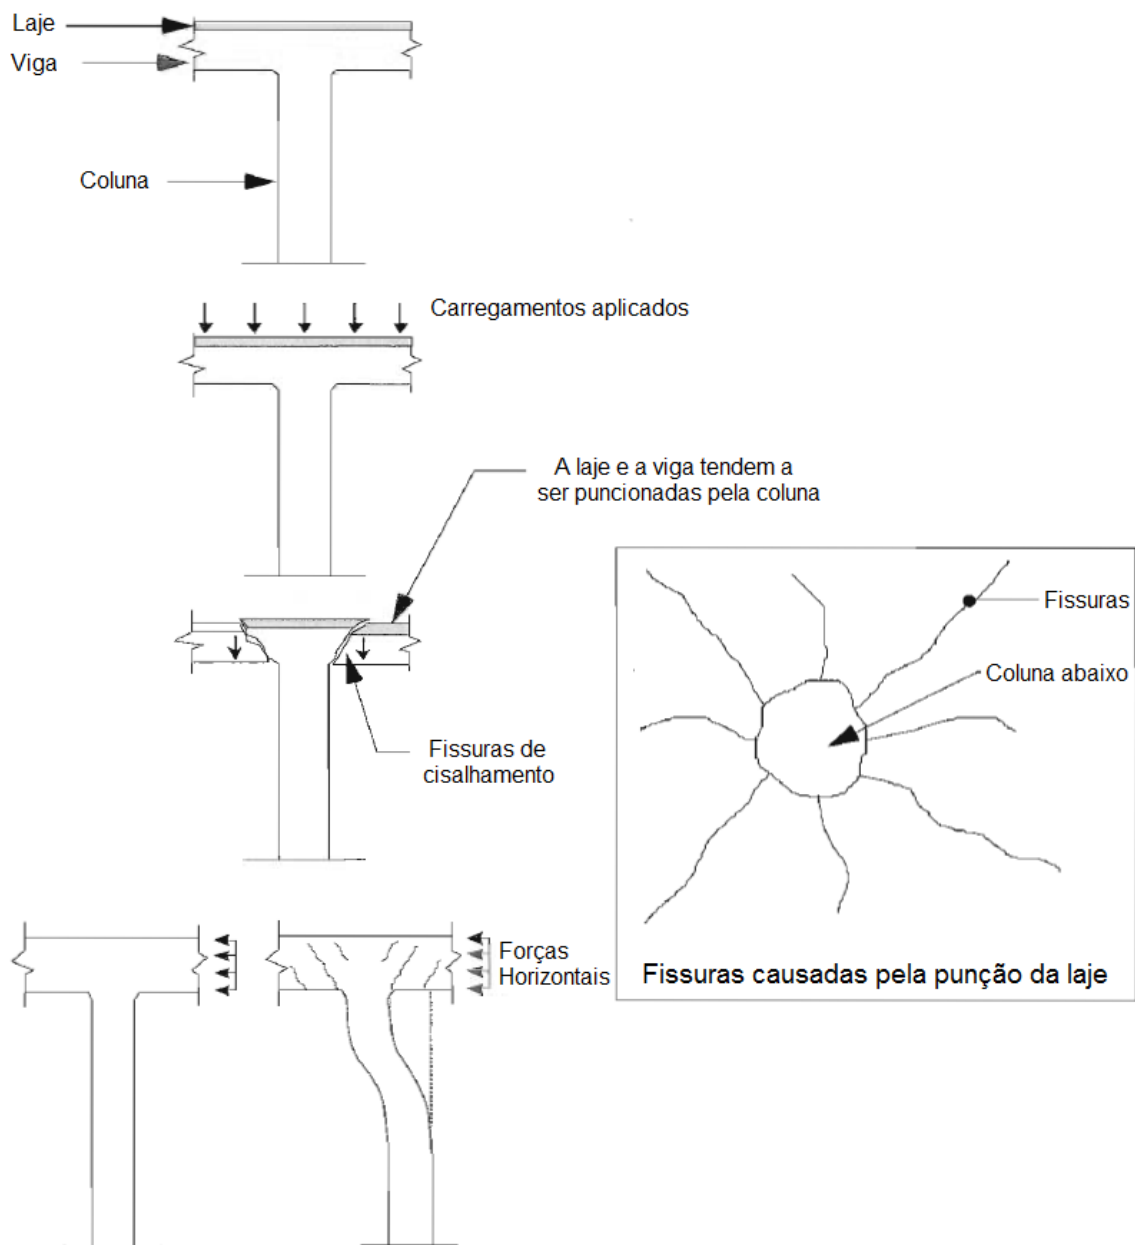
Fissuras causadas por esforços de cisalhamento entre pilares e vigas/lajes. (Fonte: Emmons, 1994 – adaptado).
